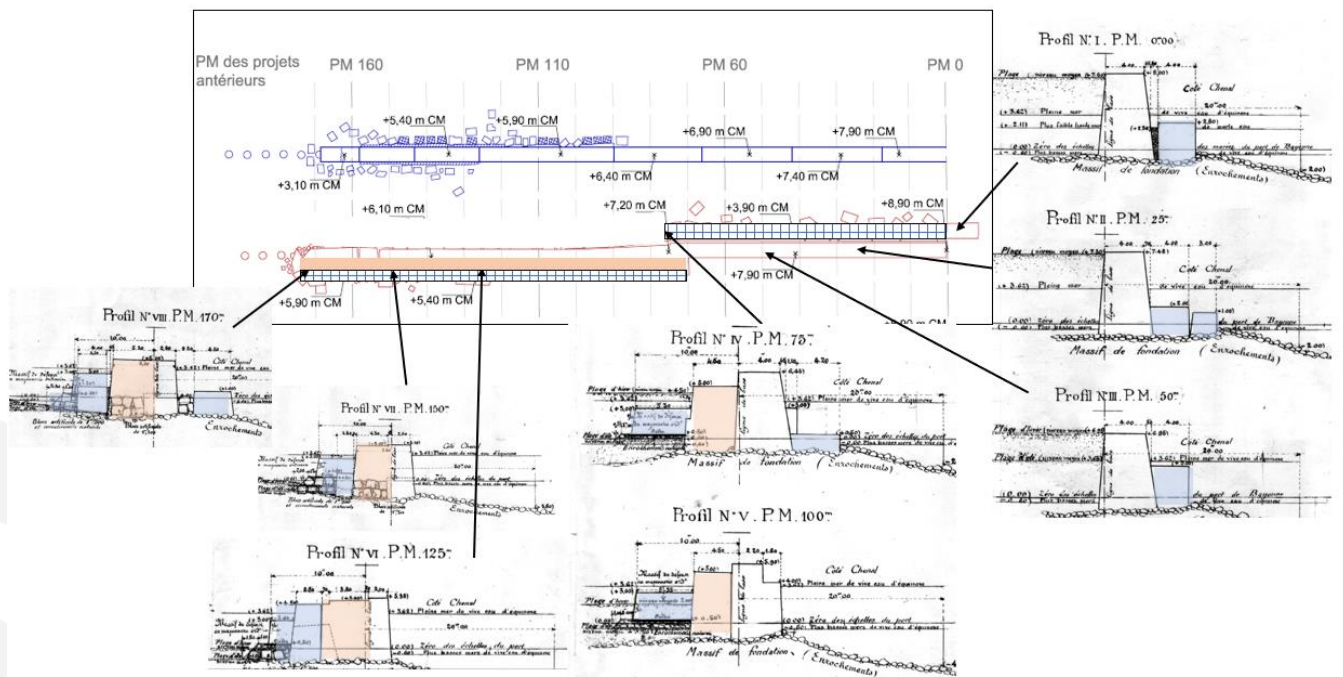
Profil en travers et plan masse de la jetée suite aux premiers renforts – sources : plans d'archive
